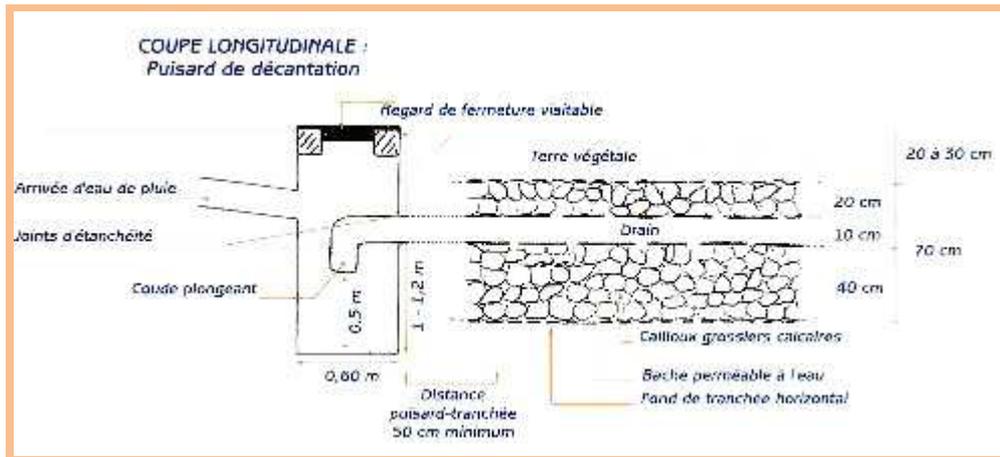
Coupe longitudinale d'un puisard de décanation¹
